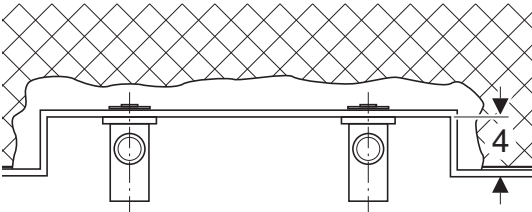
Dimensiuni de instalare pentru montarea încastrată cu placă de montaj Geberit decalată
